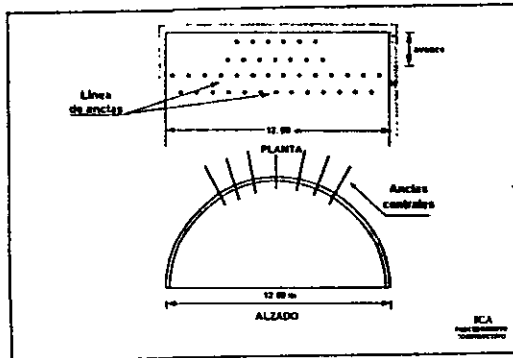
Anclaje central utilizando elementos de 1" de \varnothing x 4.2 m.
